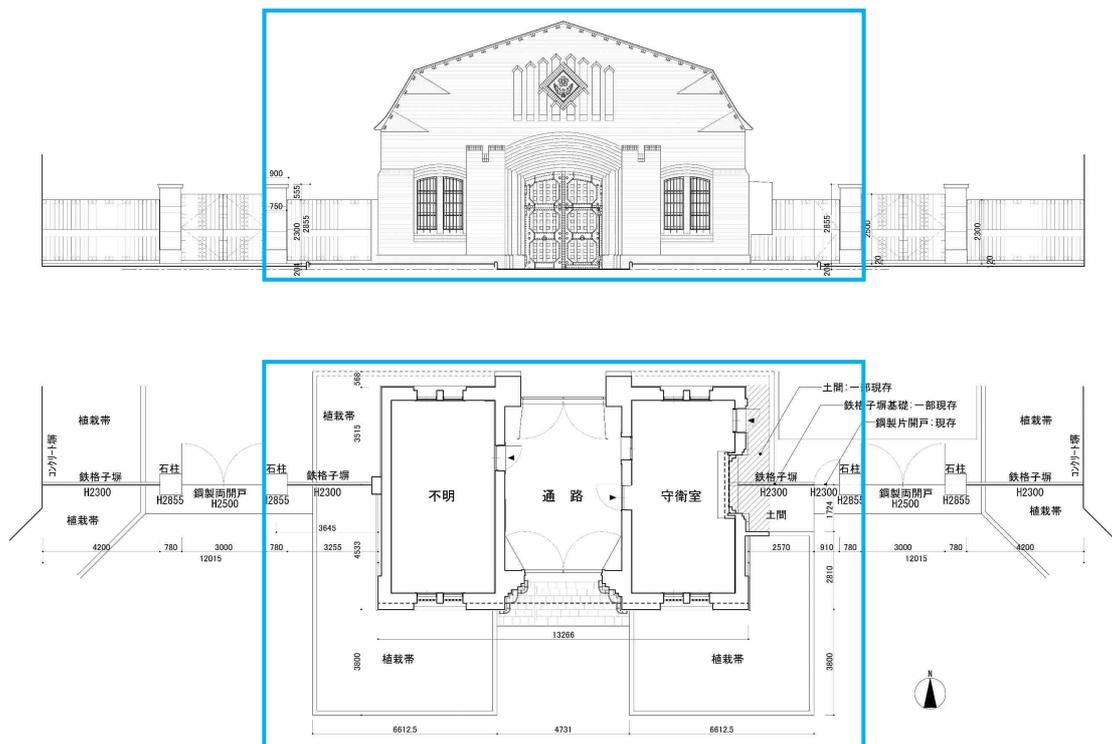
復原した外構図(青枠が整備に伴う復原範囲) 上:立面図 下:平面図
